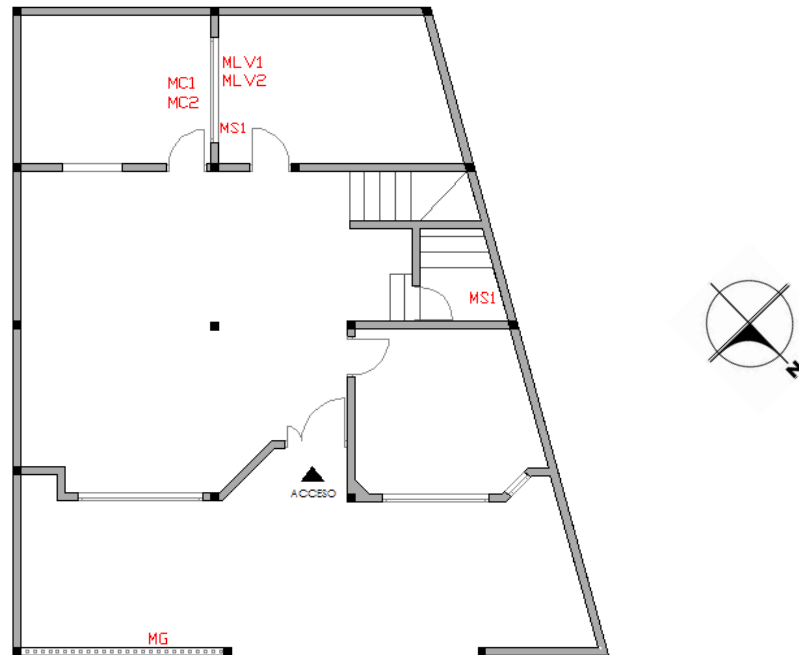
Primera Planta, lugares en donde se instaló medidores
